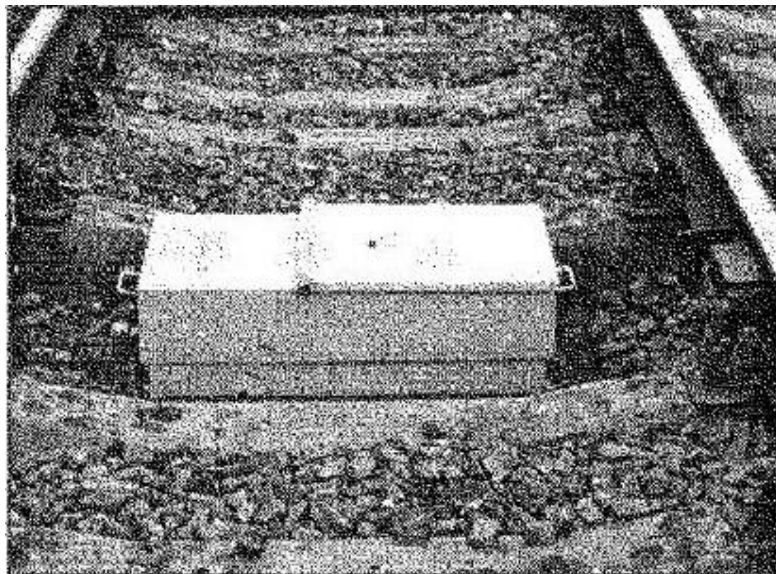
Загальний вигляд і місце розташування польової камери
